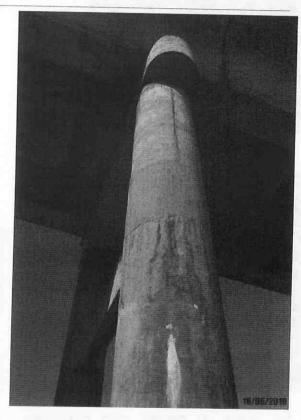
Detalhe de pilares com pequenas fissuras e pontos de desplacamento de concreto.
